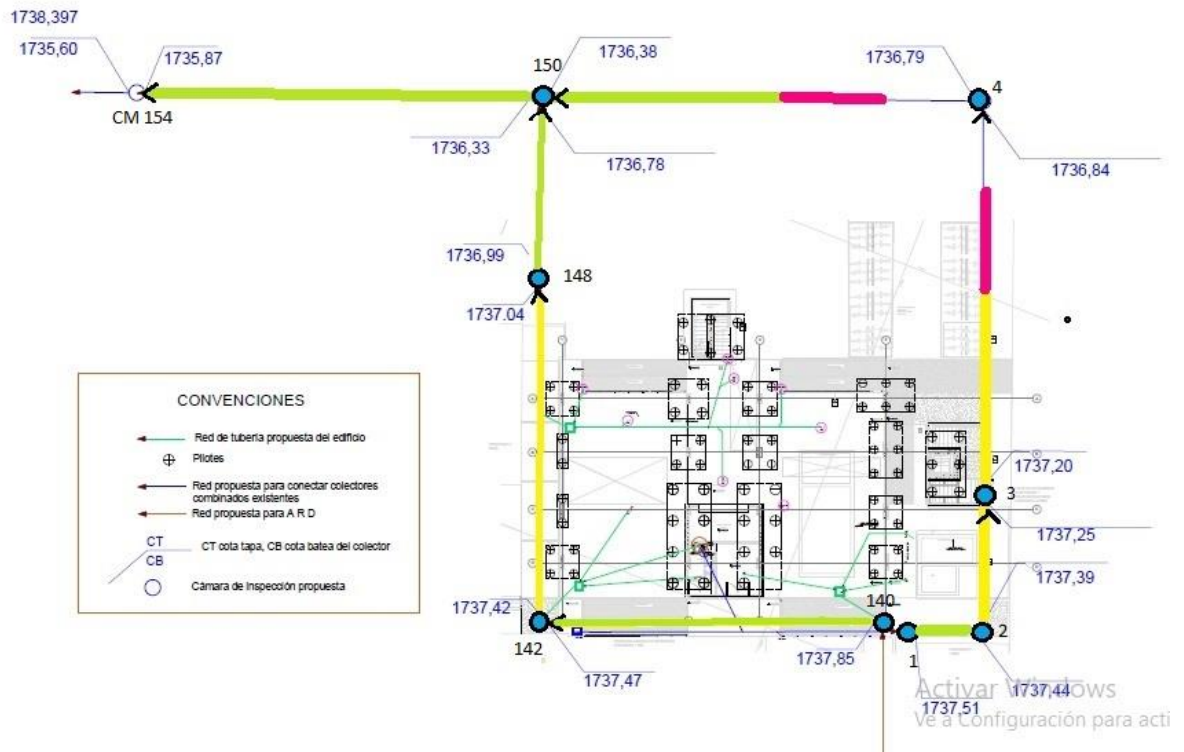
Plano de alcantarillado pluvial y sanitario julio
